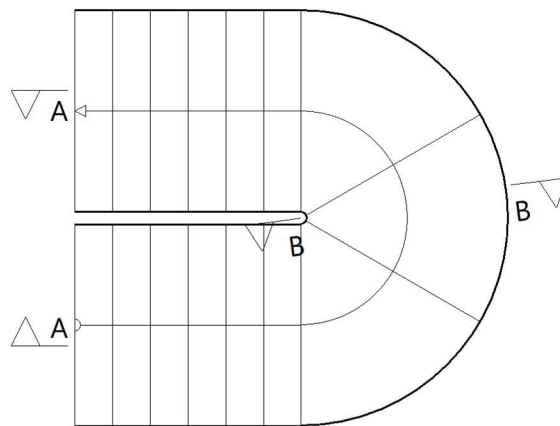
Geometría NUCLEOESC-B3.3 (P2,P3,P4-B3)
